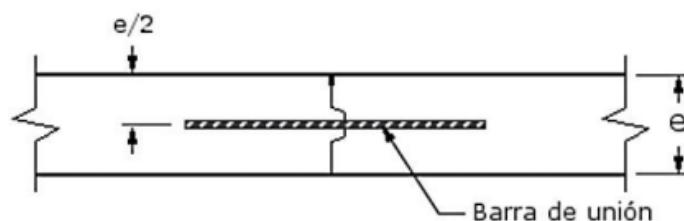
Esquema de junta longitudinal de construcción con barra de unión. (Fuente: ICPA, 2015)
